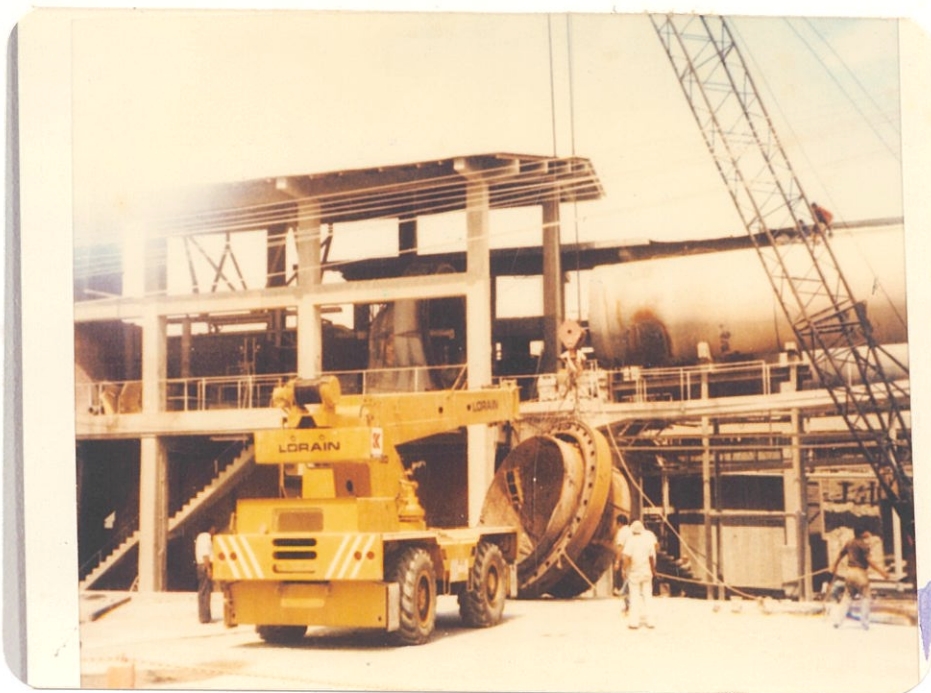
CORTE Y DESMONTAJE DE LA ZONA DE LLANTA
